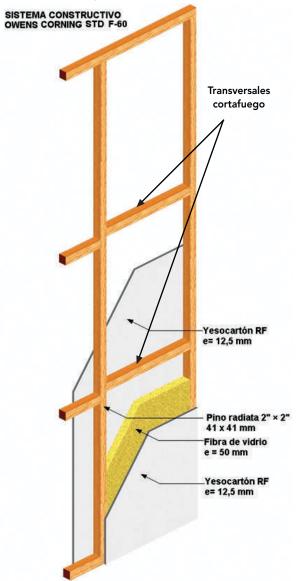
36: Elemento constructivo F-60 Owens Corning STD.
